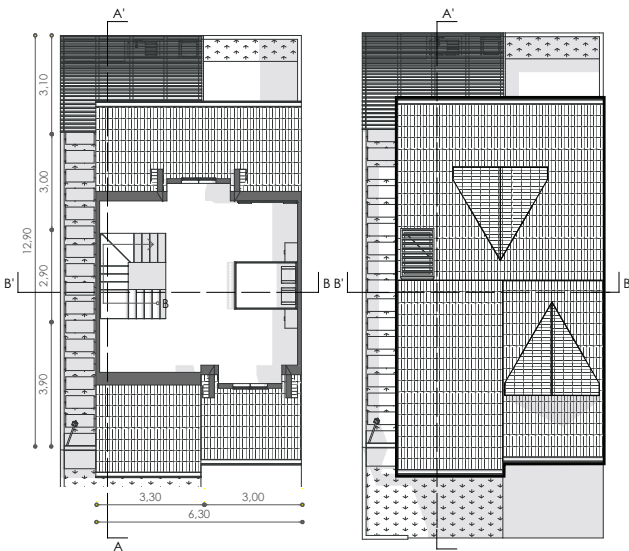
Plantas arquitectónicas remodeladas de vivienda seleccionada
